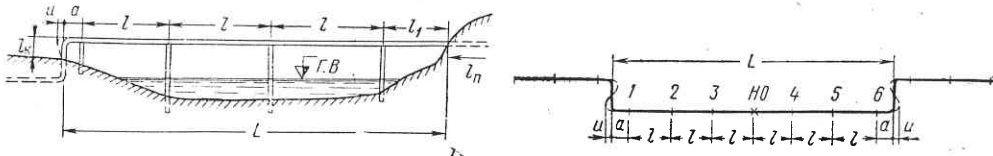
Схема балочного трубопровода с Г-образным компенсатором
